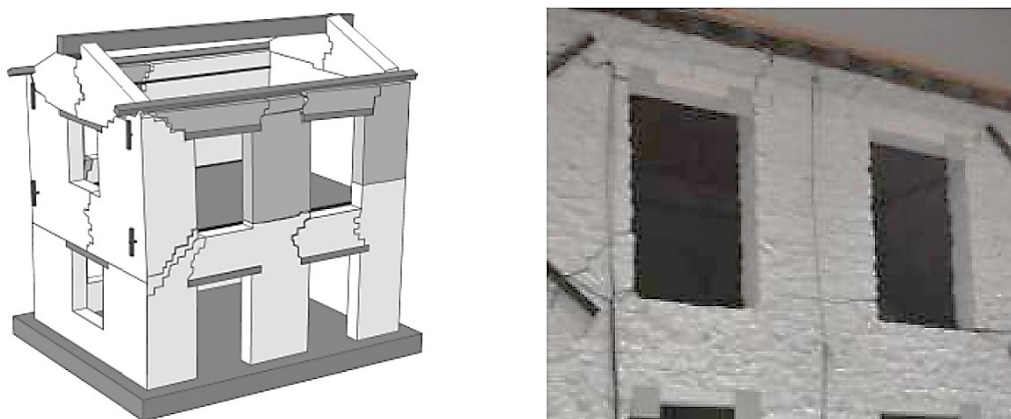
Fissuração nas paredes da estrutura reforçada após o ensaio. Fonte: [75].
